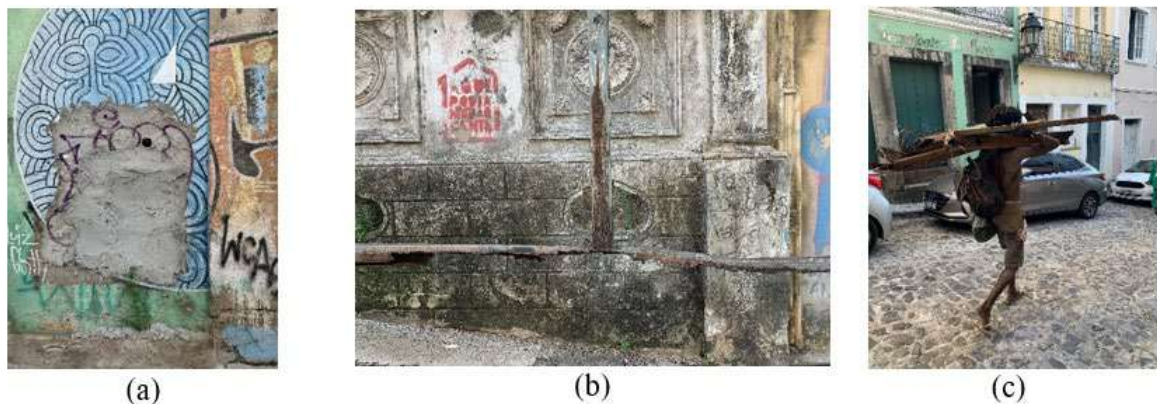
(a) Fechamento de vão com argamassas de cimento; (b) Escoramento metálico da fachada da edificação n° 45, apresentando degradação e falta de apoio; (c) Vandalismo.
